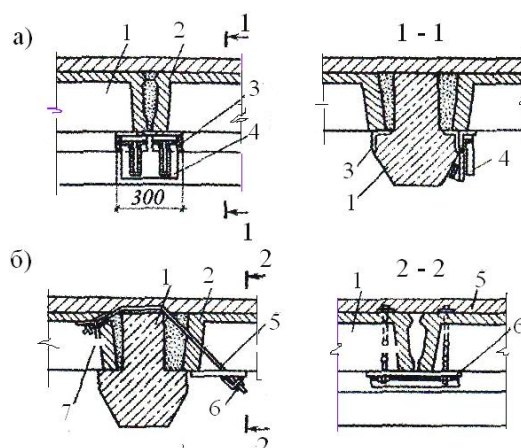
Варианты усиления мест опирания сборных железобетонных плит перекрытия на ригели:
